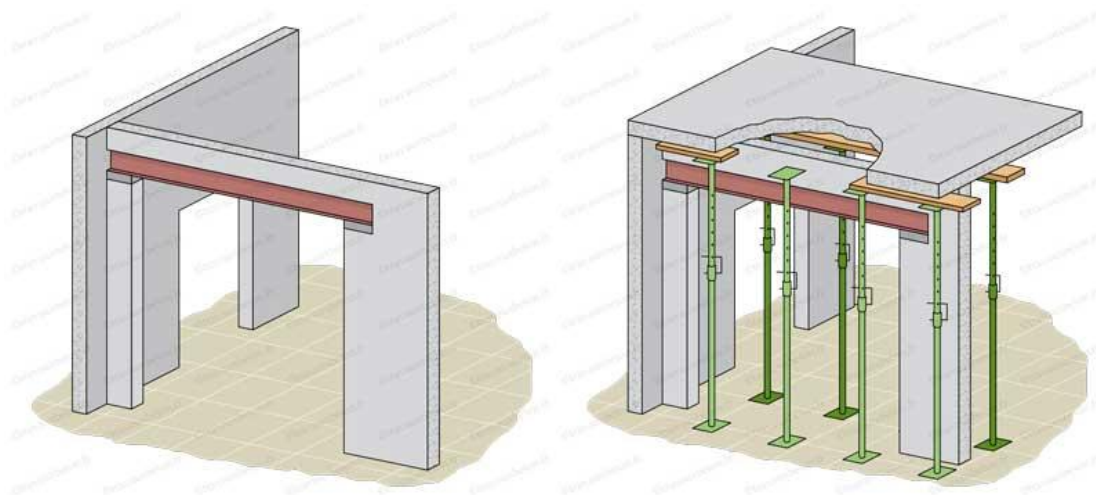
OUVERTURE DANS UN MUR PORTEUR SOURCE : TRAVAUX BETON.FR
